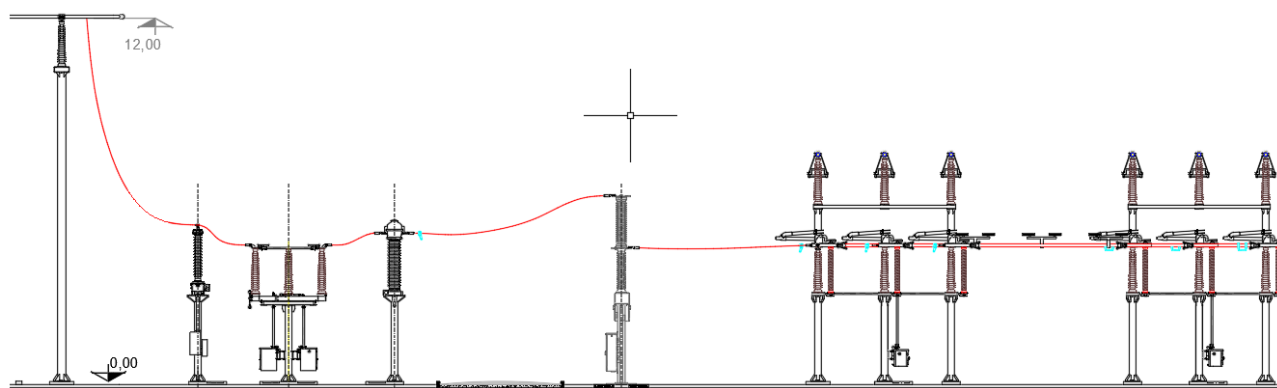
sezione stallo di arrivo in Stazione Elettrica RTN
